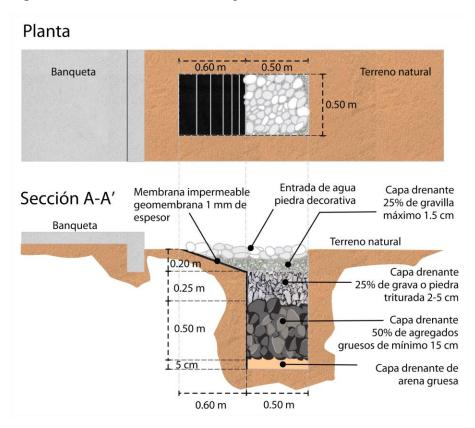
Detalle constructivo de pozo de infiltración sin revestimiento
